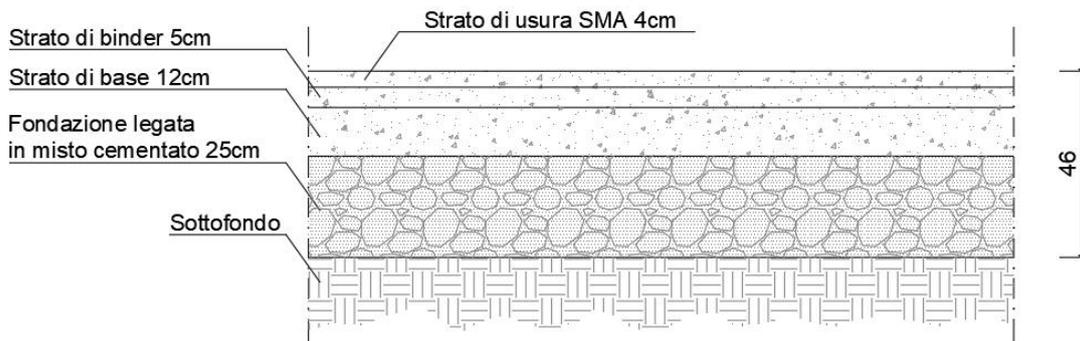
Composizione sovrastuttura ripristino pavimentazione SR65 o strada Cavet – TIPO P3A
